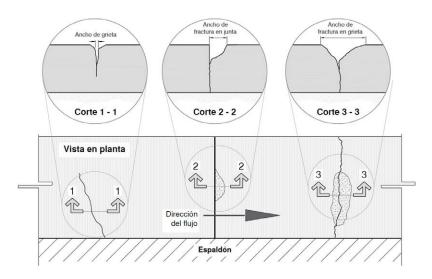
Medición del espesor de grietas, juntas y fracturas
